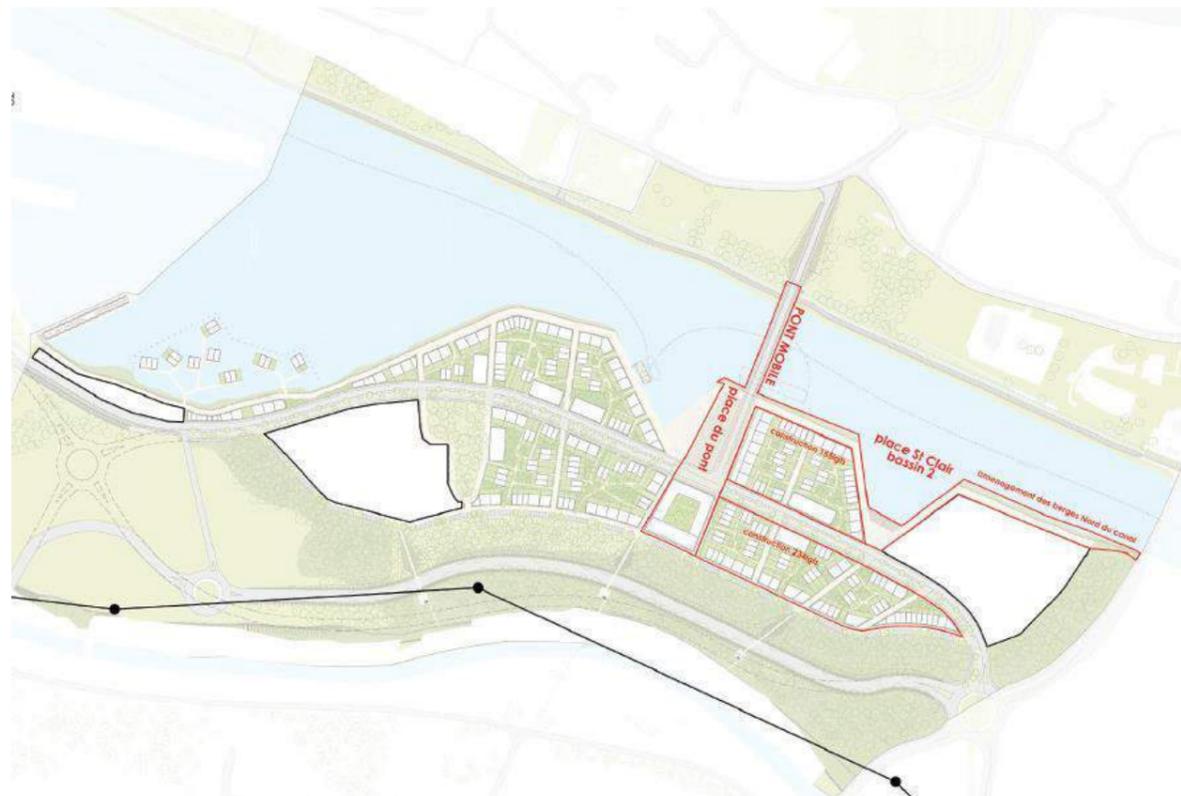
Phase 3 – Site Paysages habités à Hérouville (source : Plan Guide MVRDV)
